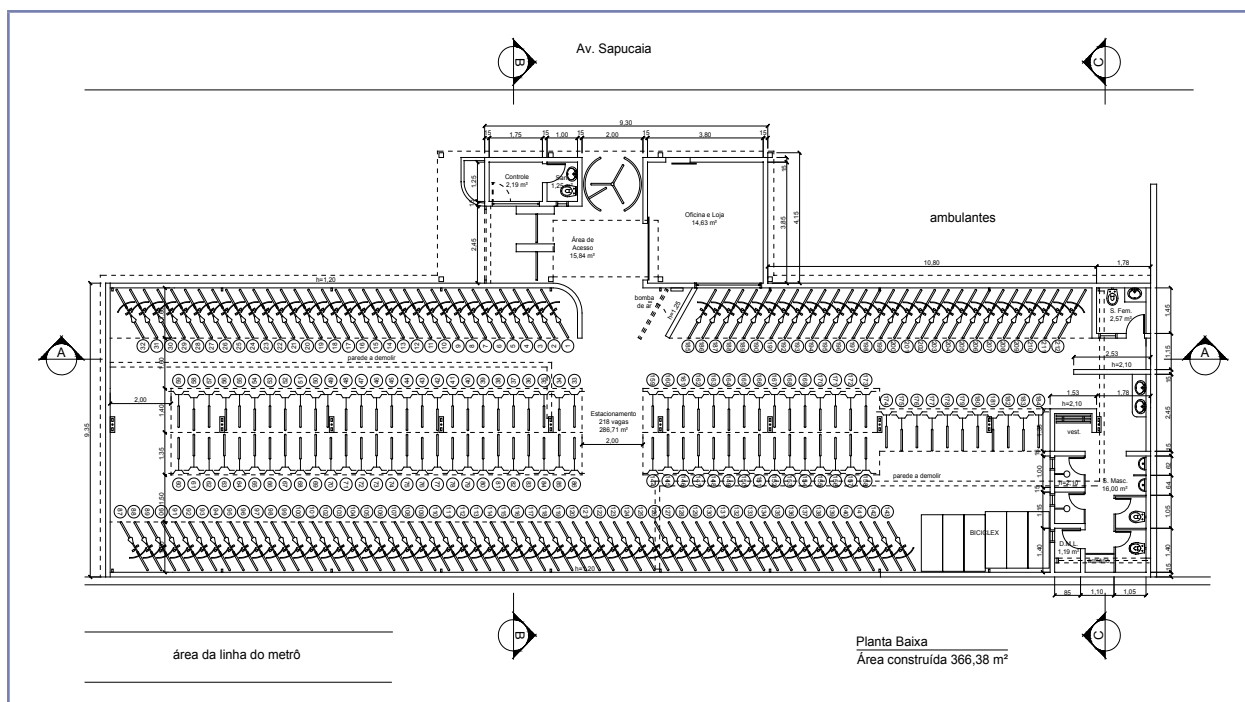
Planta baixa parcial do Projeto de Sapucaia – Porto Alegre/RS, Brasil, agosto de 2005⁸
